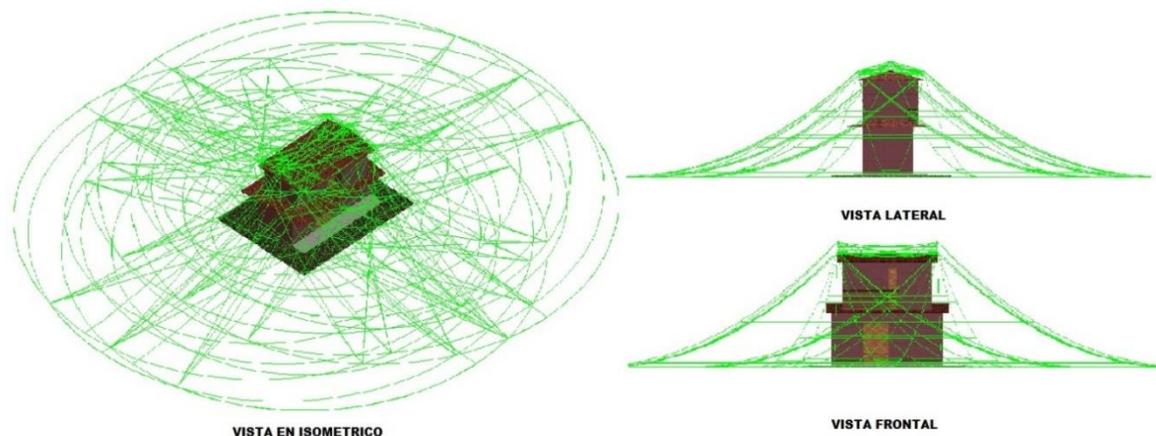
Vista 3D de la zona de protección del nivel de captación externo vivienda prefabricada (los autores).
